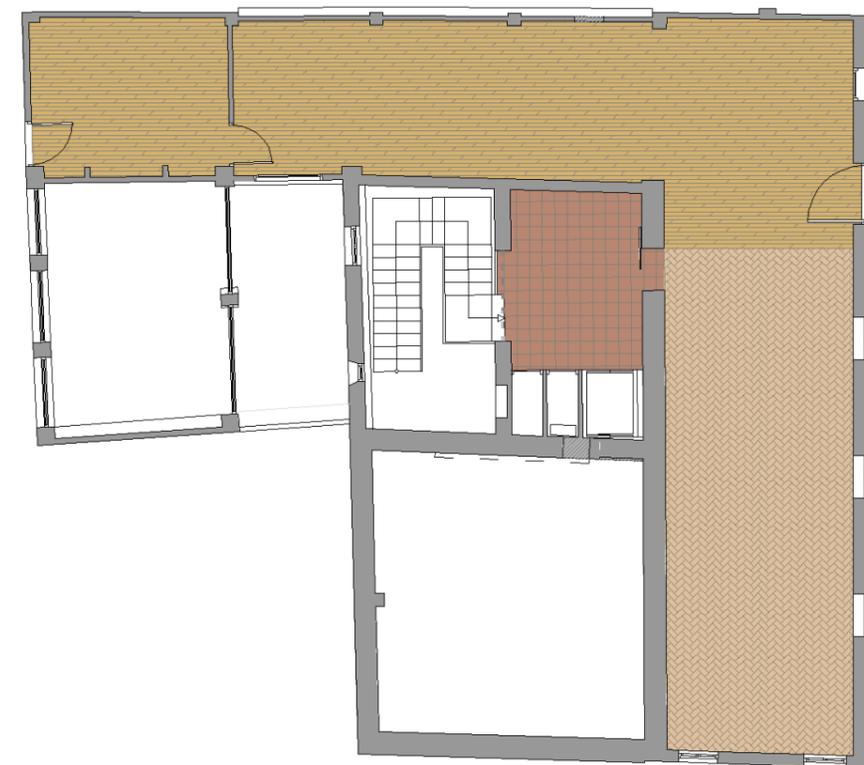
Pavimento de baldosa cerámica en la Cambra de la Alquería. Fuente: Propio autor.
